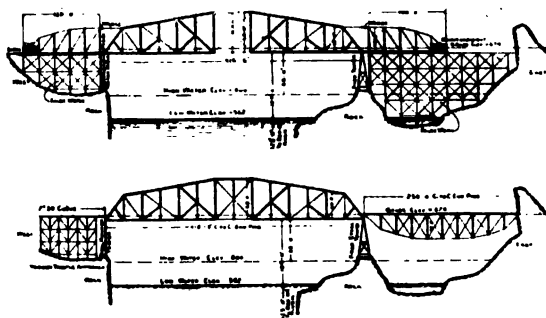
Montage en porte-à-faux d'une travée indépendante de 126^m,95, sur la Colombie, par l'Edgo Moor Bridge Co (d'après l'Engineering Record).
